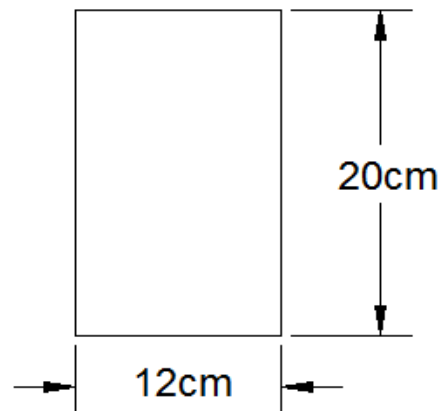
Coupe schématique de la poutrelle (appuis)
